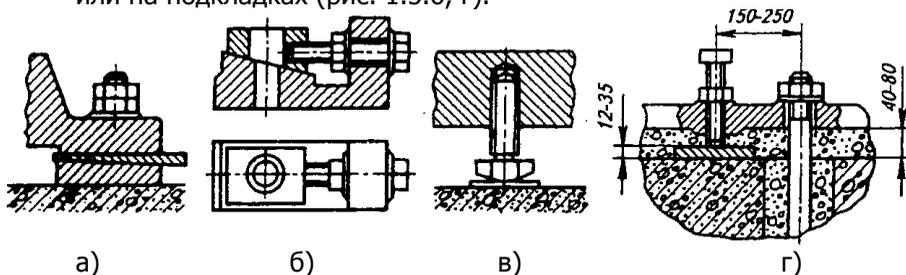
Приспособления для выверки расположения машины по высоте
